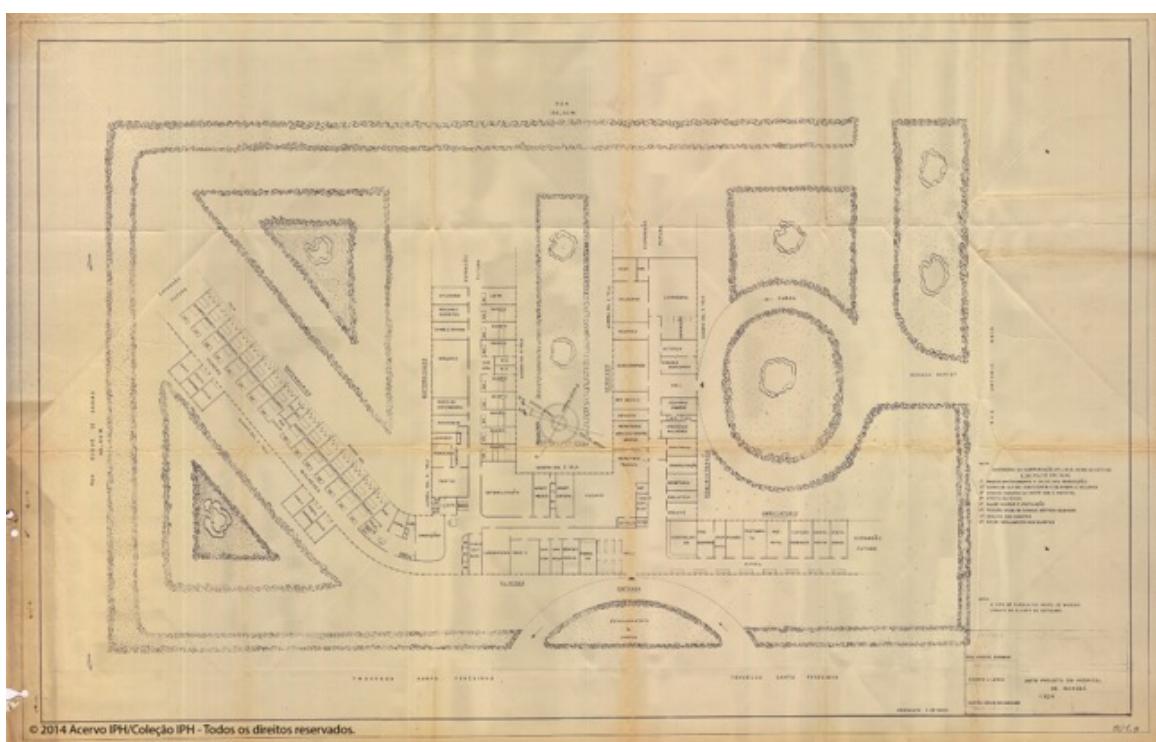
Prancha com planta baixa da primeira versão do Hospital de Marabá.
